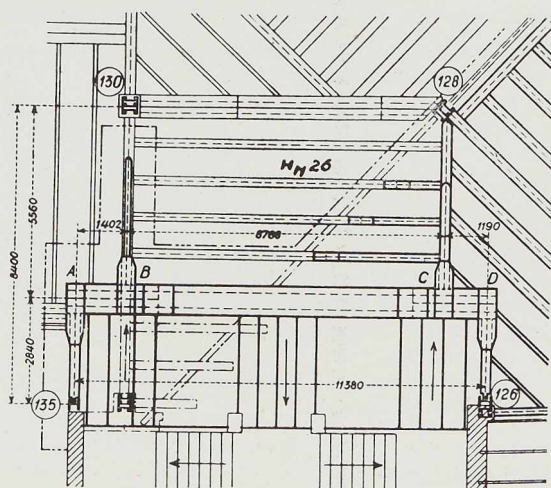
Dégagement de la cage d'escalier par l'emploi de poutres travaillant à torsion.
